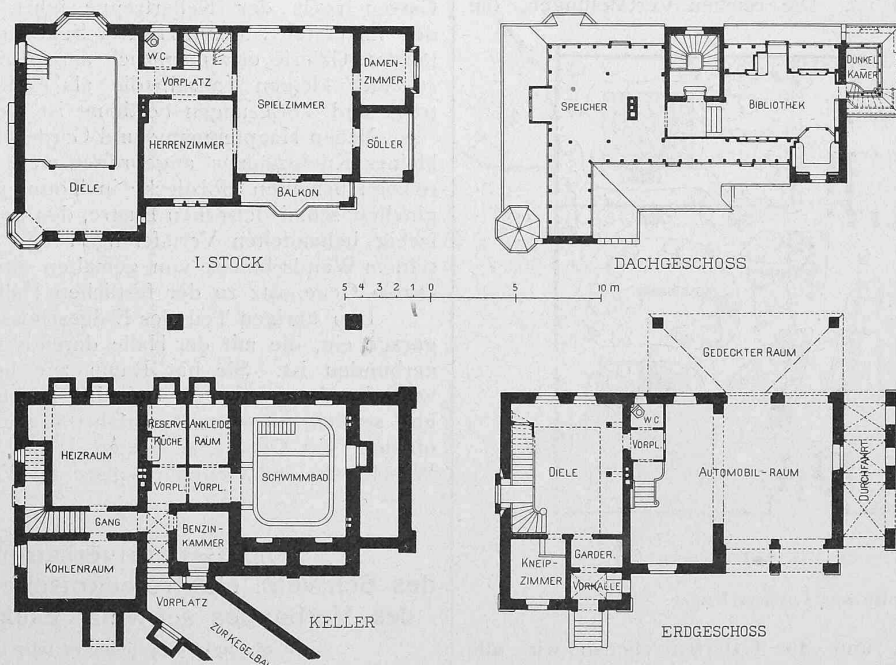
bis 6. Grundrisse vom Keller-, Erd-, Haupt- und Dachgeschoss. — Masstab 1:400.
